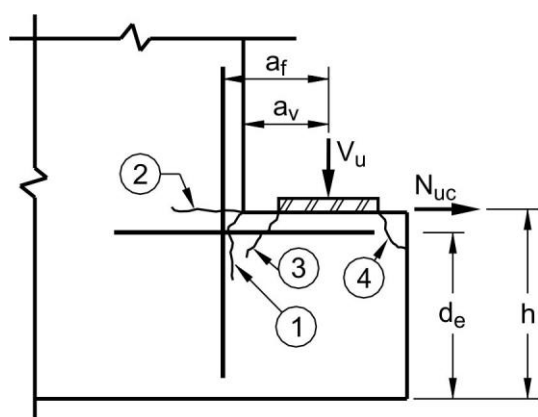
Simbología y ubicación de las fisuras potenciales en vigas con resaltos horizontales
